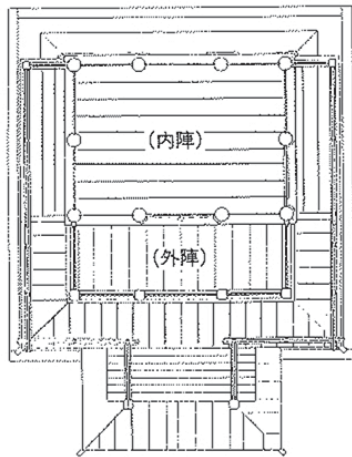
国宝 苗村神社西本殿平面図 図-4 重要文化財 延暦寺常行堂平面図
